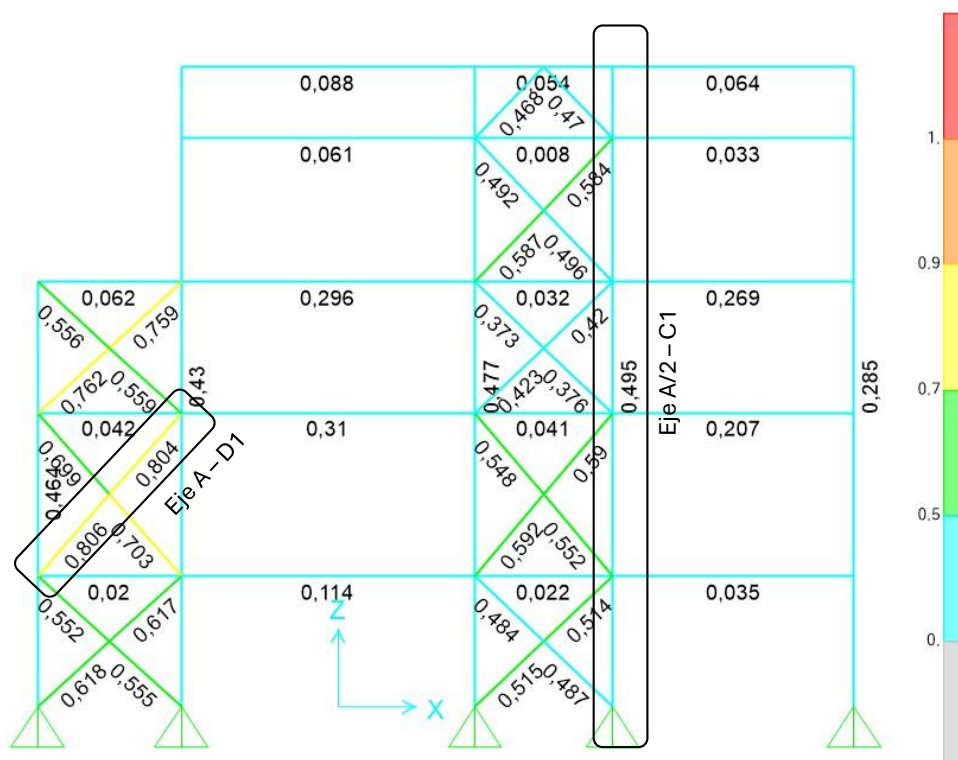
F.U. Eje A, plano XZ, Y=-3.3
